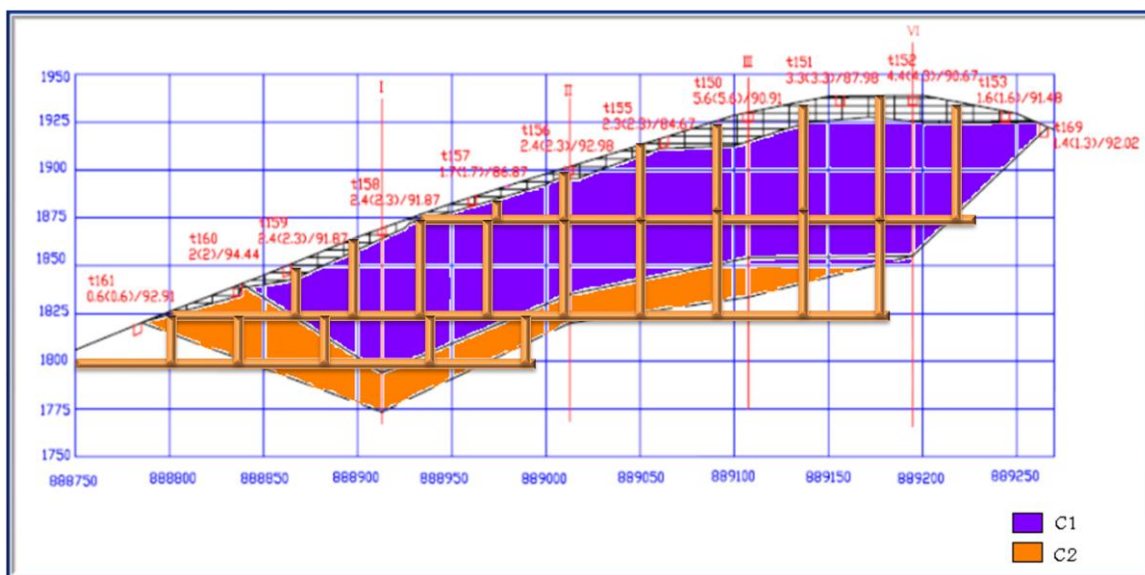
Projection sur plan vertical des travaux de découpage filon n°10
